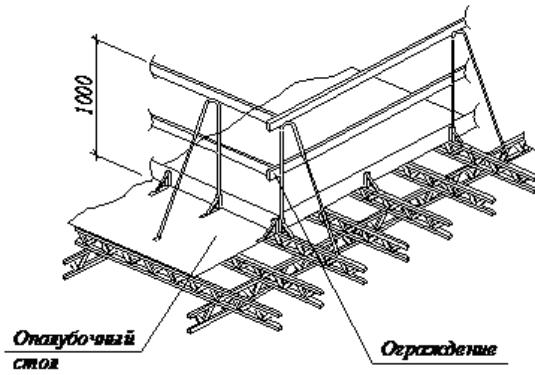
Ограждение опалубки перекрытий
